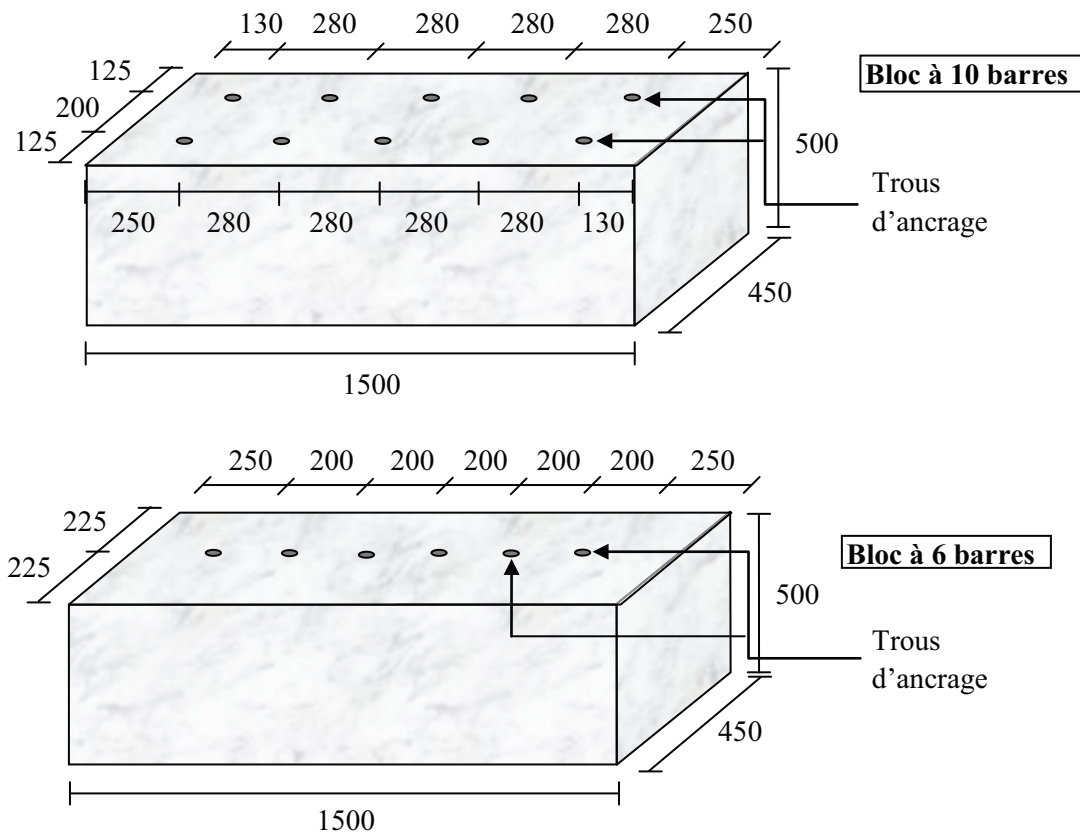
Configuration des ancrages dans les substrats de béton. Distances en mm.
